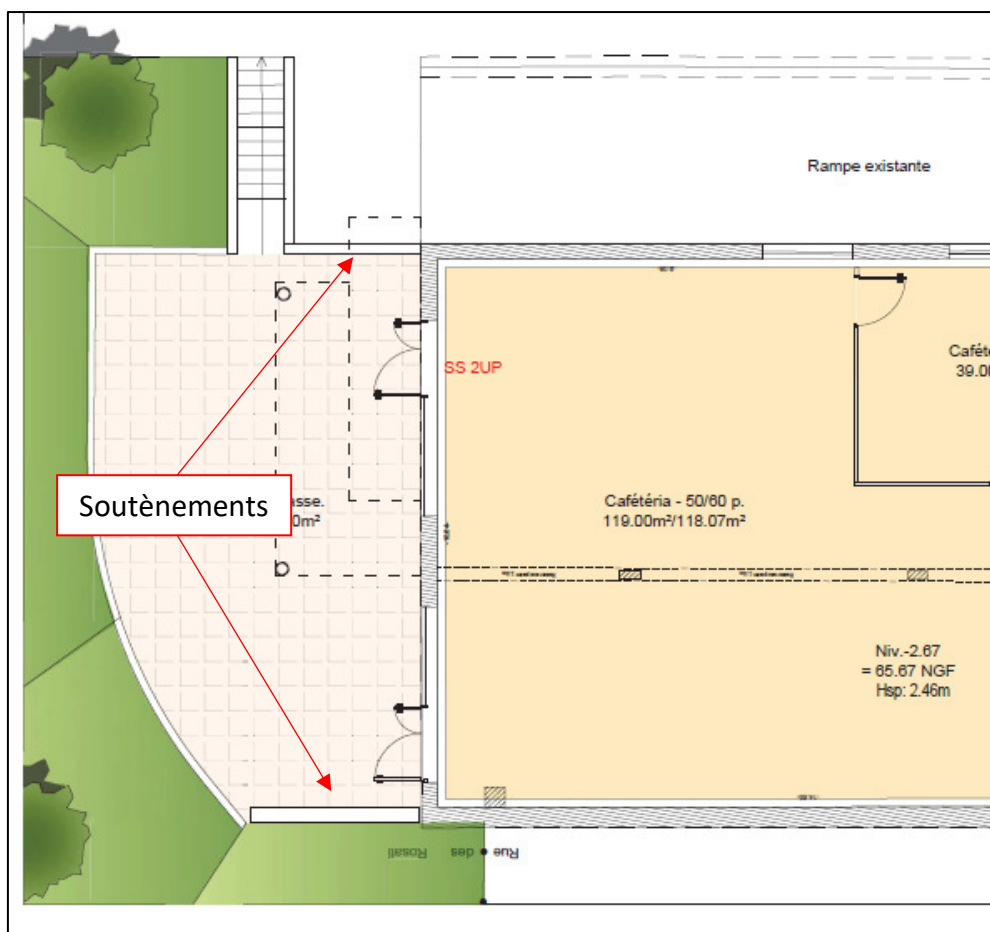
Localisation des soutènements (extrait du plan de masse du projet)
